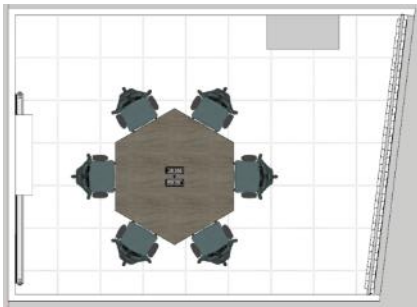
Detail Tampak Atas Meja Alternatif Desain 1
